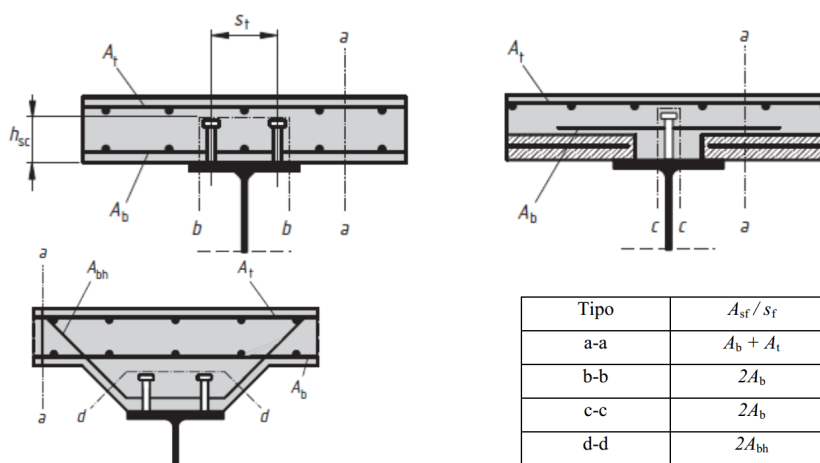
Superfícies de corte longitudinal com lajes maciças ou com recurso a elementos de betão pré-fabricado (CEN, 2011).
